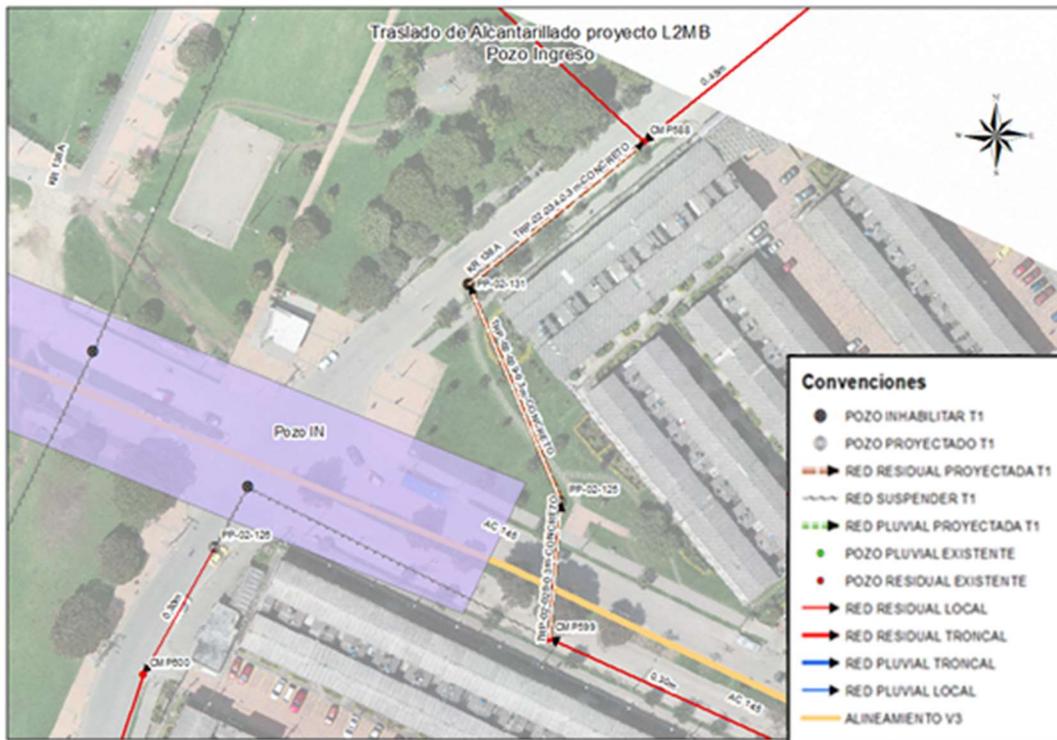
Traslado de redes de Alcantarillado Pozo de Entrada Carrera 138A con Calle 146 Red Residual
